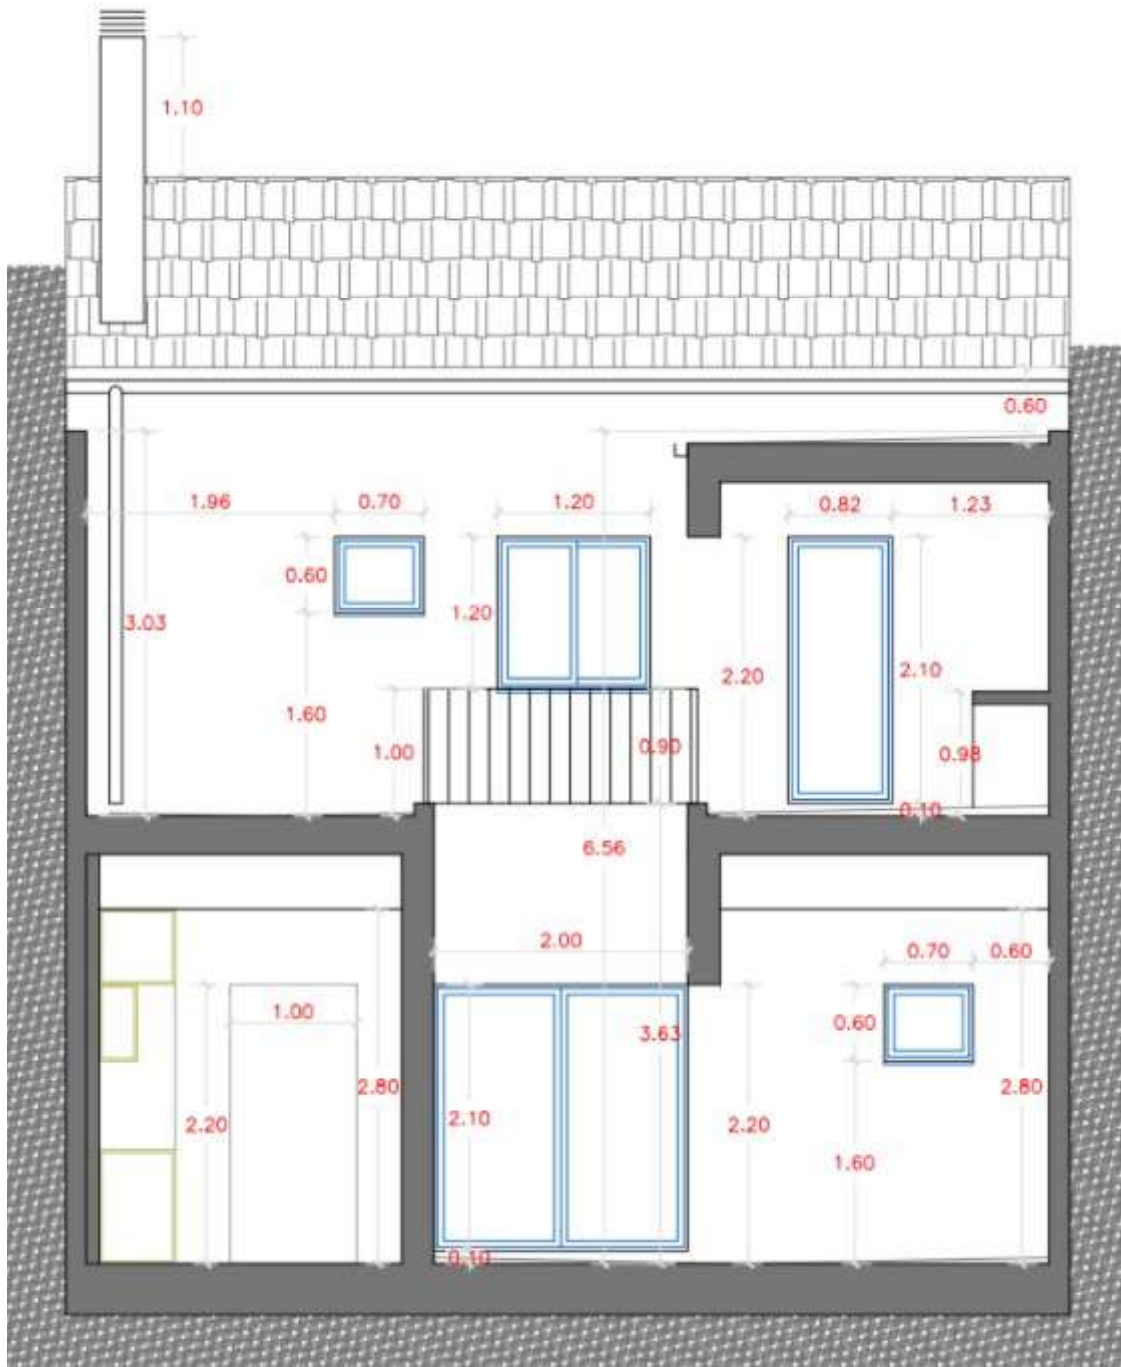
Sección III vivienda proyectada (proyecto básico)
